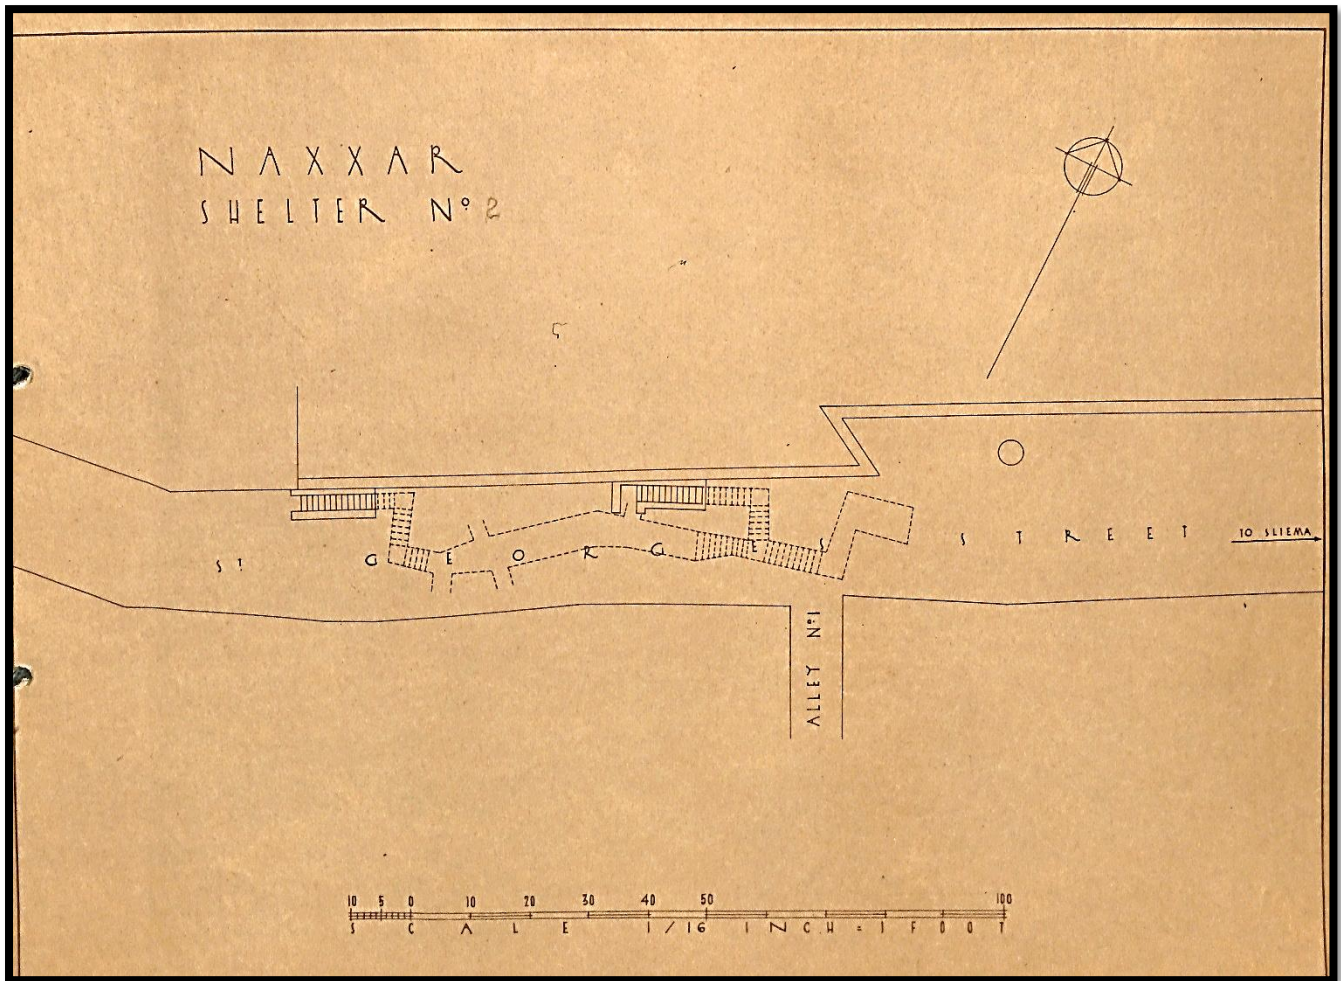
Planta do Abrigo nº2 "St. George's Street"
